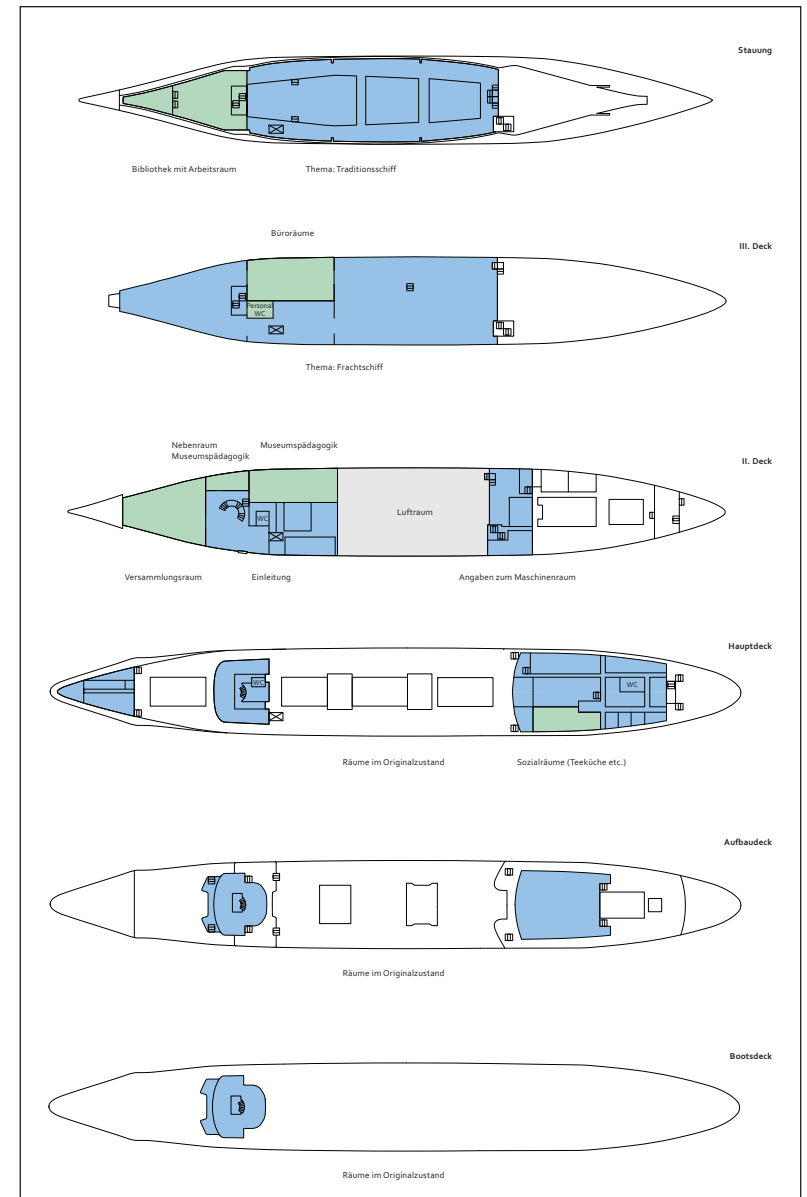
Schematische Grundrisse Traditionsschiff
